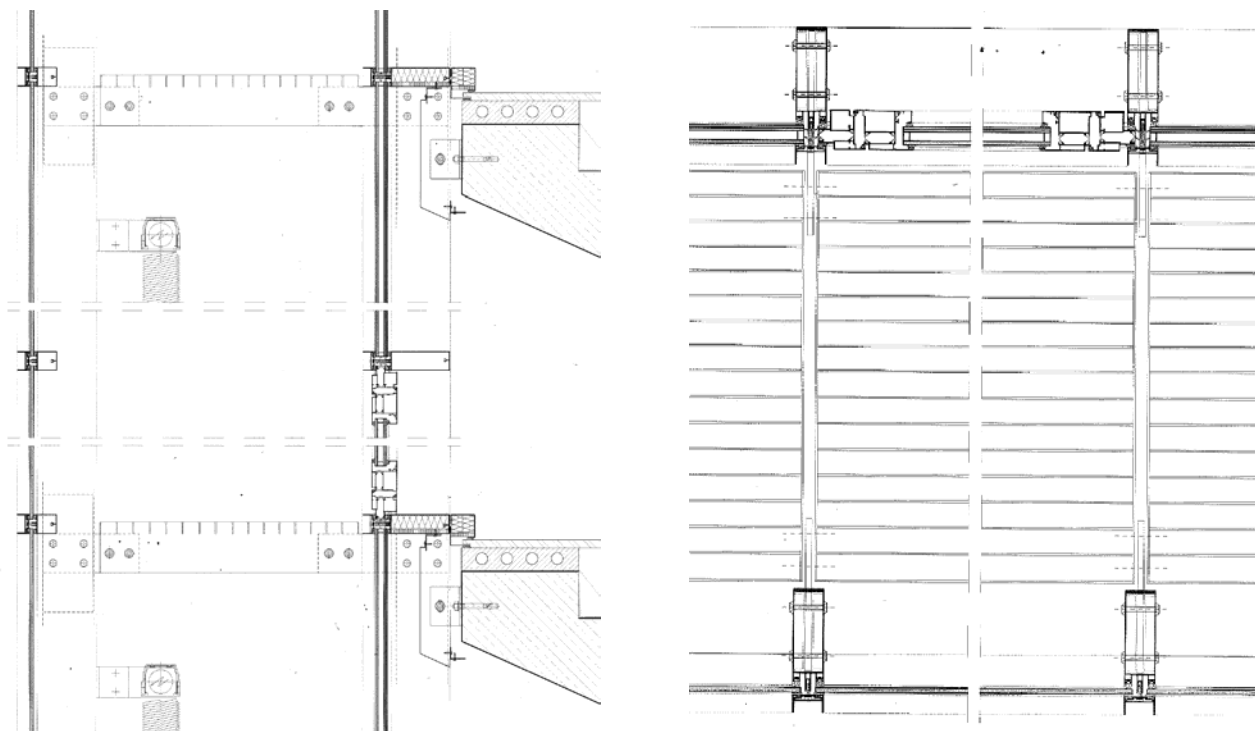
Fachada de doble piel tipo multiplanta. Sección vertical y planta tipo.
